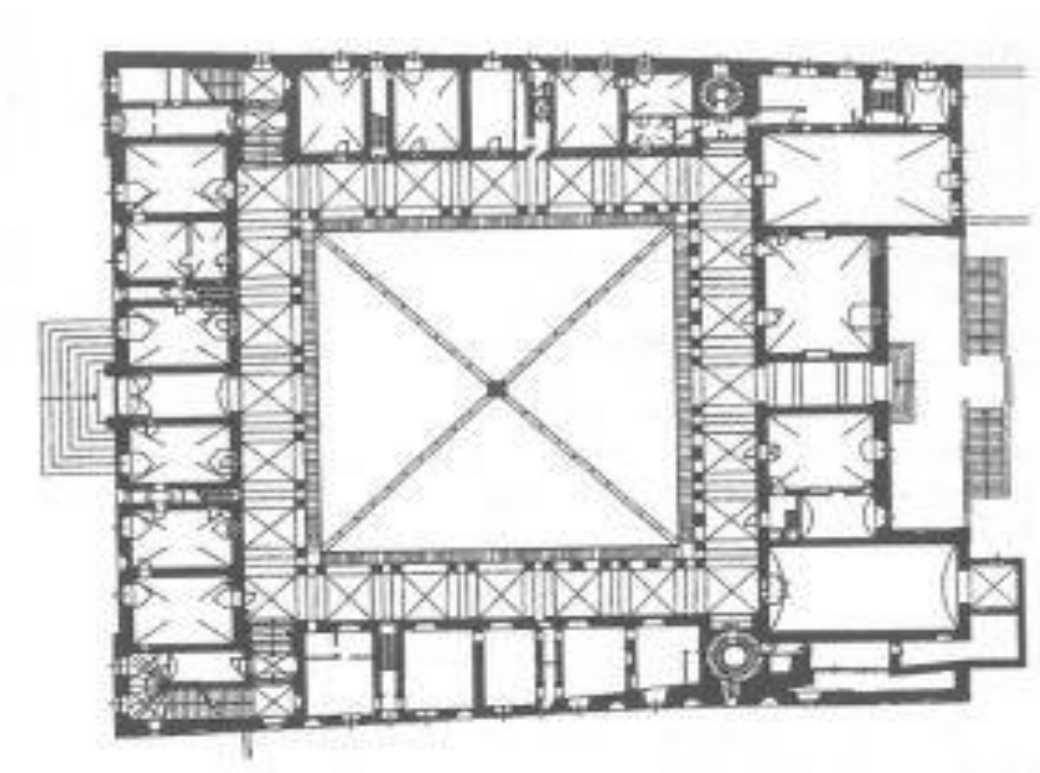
Pianta piano primo Collegio Borromeo - Fonte: www.lombardiabenculturali.it
